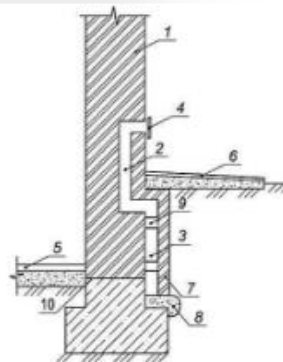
Восстановления несущей способности фундаментов путем устройства воздушных каналов с наружной стороны стены (защита от замачивания): 1 – осушаемая стена; 2 – канал; 3 – пробиваемый в стене; 4 – вентиляционная решетка; 5 – пол аэрируемого этажа; 6 – отмостка; 7 – стенка воздушной щели (из кирпича толщиной 120мм); 8 – бетонное основание под стенку; 9 – распорки; 10 – существующая горизонтальная гидроизоляция
